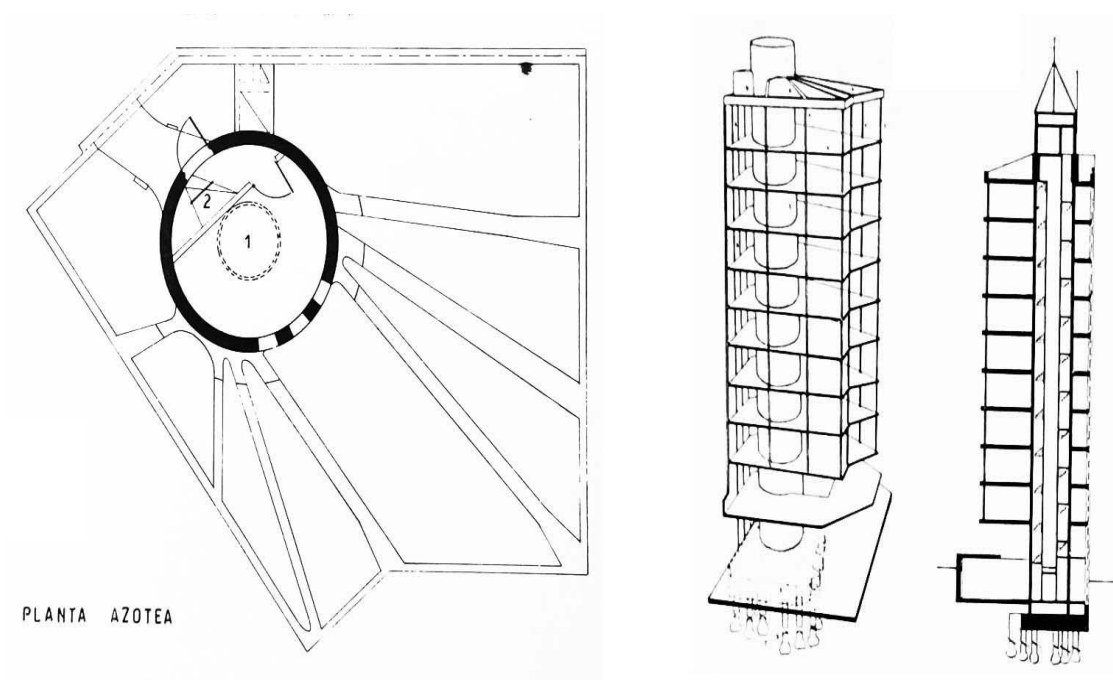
Planta a nivel de azotea y esquema de la estructura del edificio El Pilar. Fuente: Centro de documentación del Instituto de Historia, FADU, Udelar.
